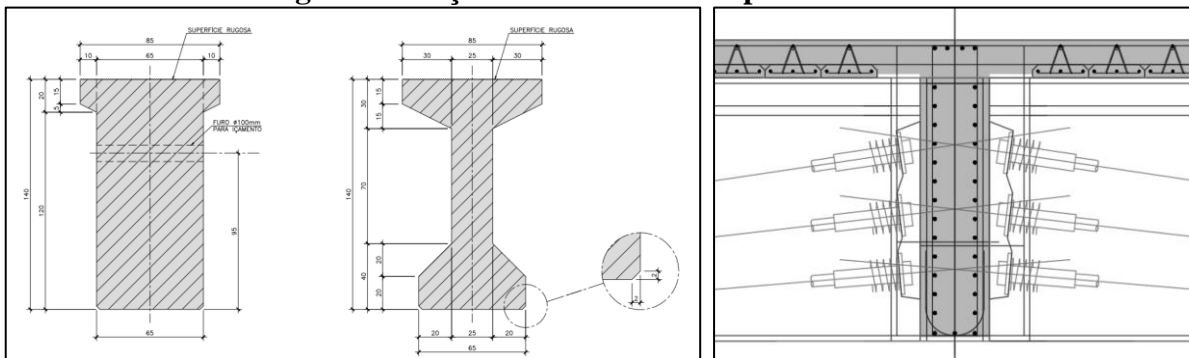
Seção transversal da longarina e detalhe da armadura de consolidação
